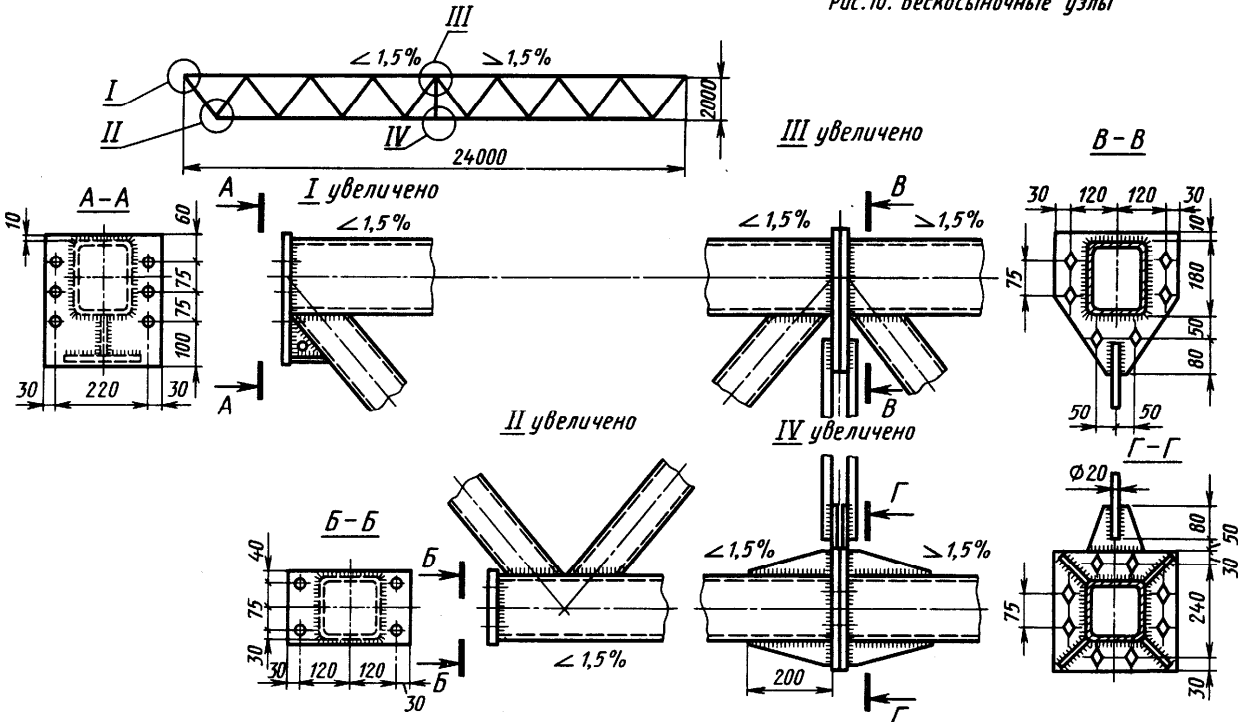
Стропильная ферма пролетом 24м из прямоугольных труб
